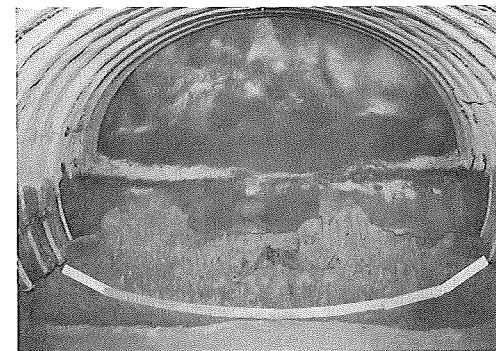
吹付けコンクリートによる早期閉合状況(施工単位3m)
